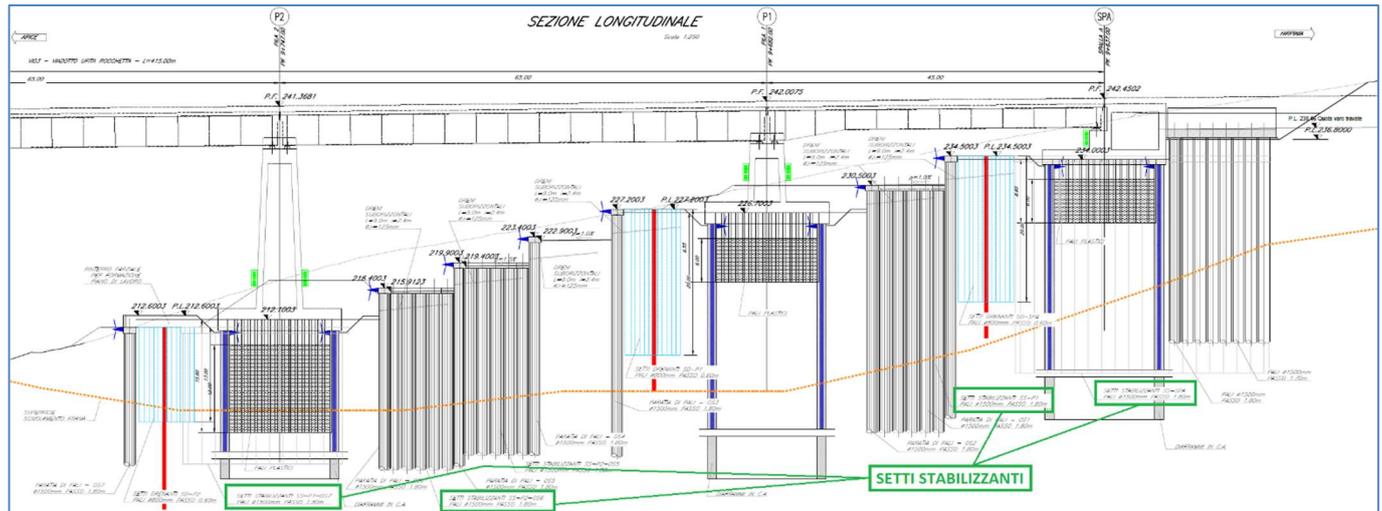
Profilo Longitudinale con indicazione dei Setti Stabilizzanti
